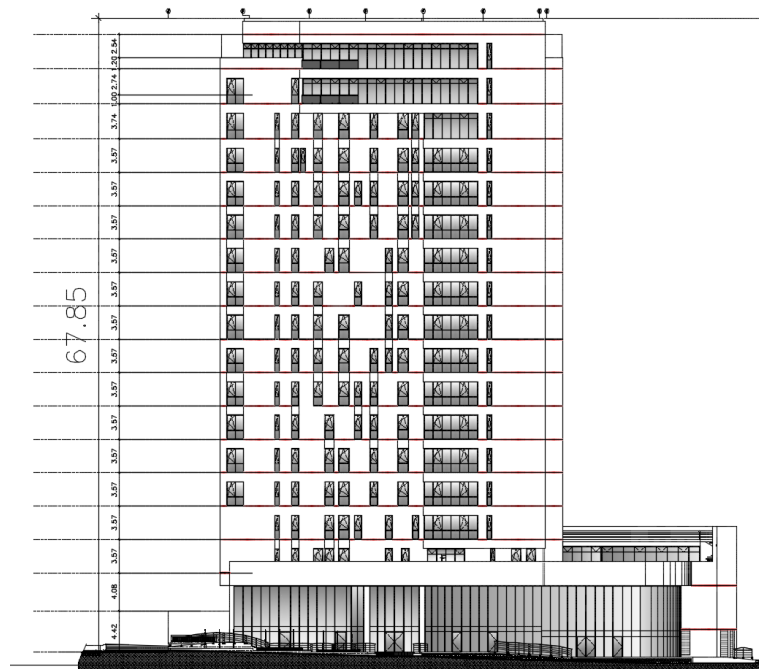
Fachada del edificio de apartamentos del presente proyecto
